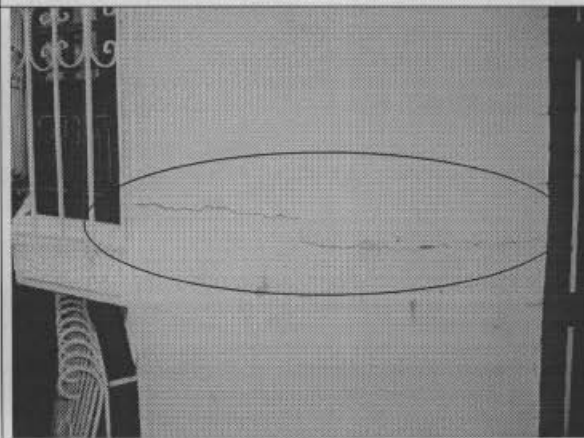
Muros de la fachada de la vivienda con agrietamientos.
